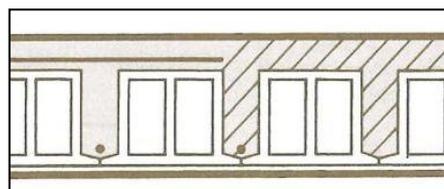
Stahlbetonrippendecken mit Systemziegeln als Füllkörper, bewehrt (links) und unbewehrt (rechts) [1b]
